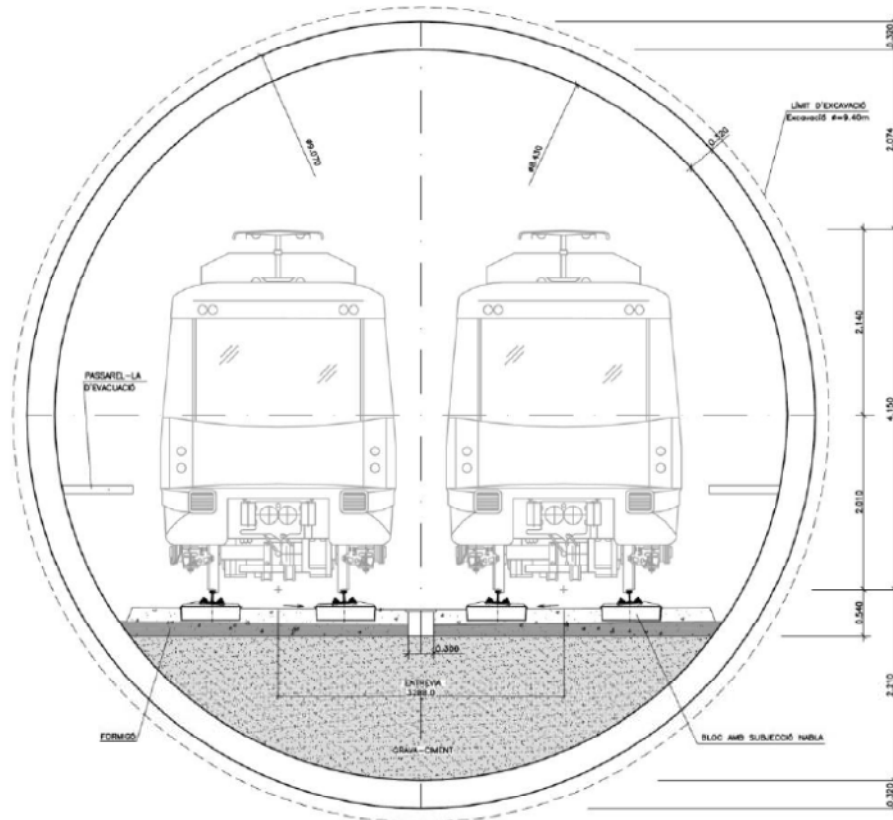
Sección de tuneladora de 9,40 m (L9).
